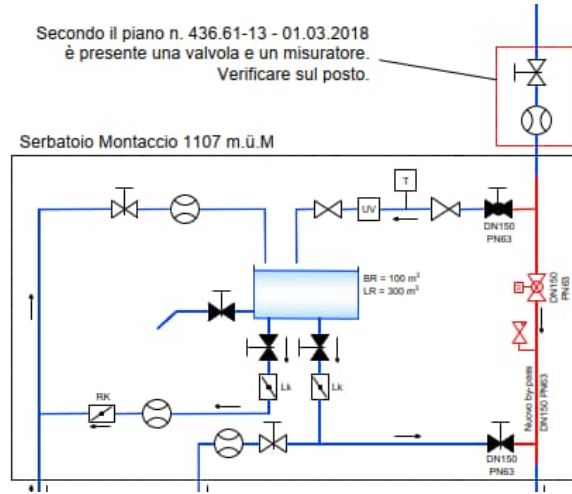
Serbatoio Montaccio: stato attuale con flange di connessione e schema principale con bypass (rosso)
